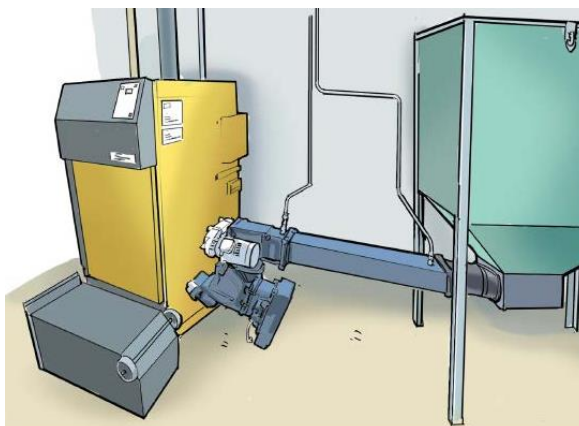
Exempel på modern fliseldning från Länsförsäkrings "BRASA"
